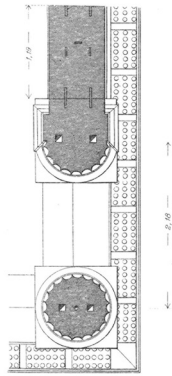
Detailansicht der Nordostecke der Südhalle (M. 1 : 100)
